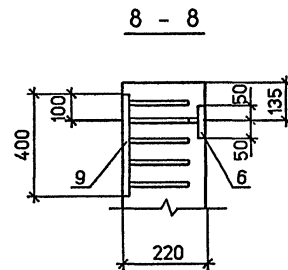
Для крепления связей к средним фермам в покрытии с железобетонными плитами при сейсмических нагрузках
